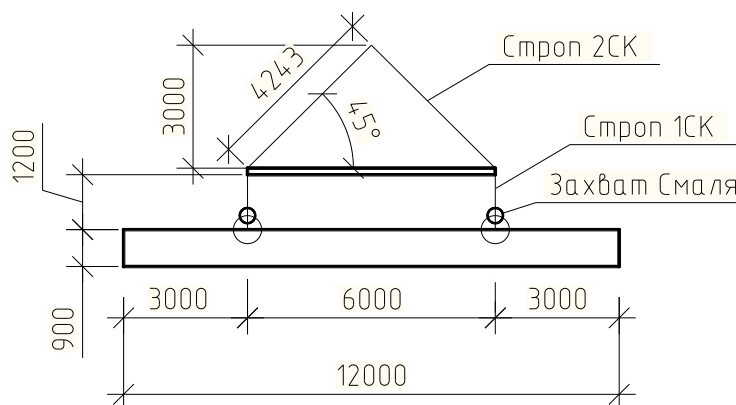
Определение длины стропы для монтажа подкрановых
